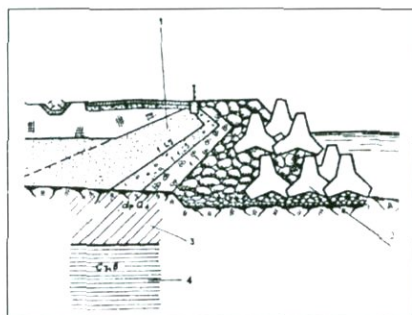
Конструкция берегоукрепительных стен из монолитного бетона БМ-200 и конструкции рибермы из камня
